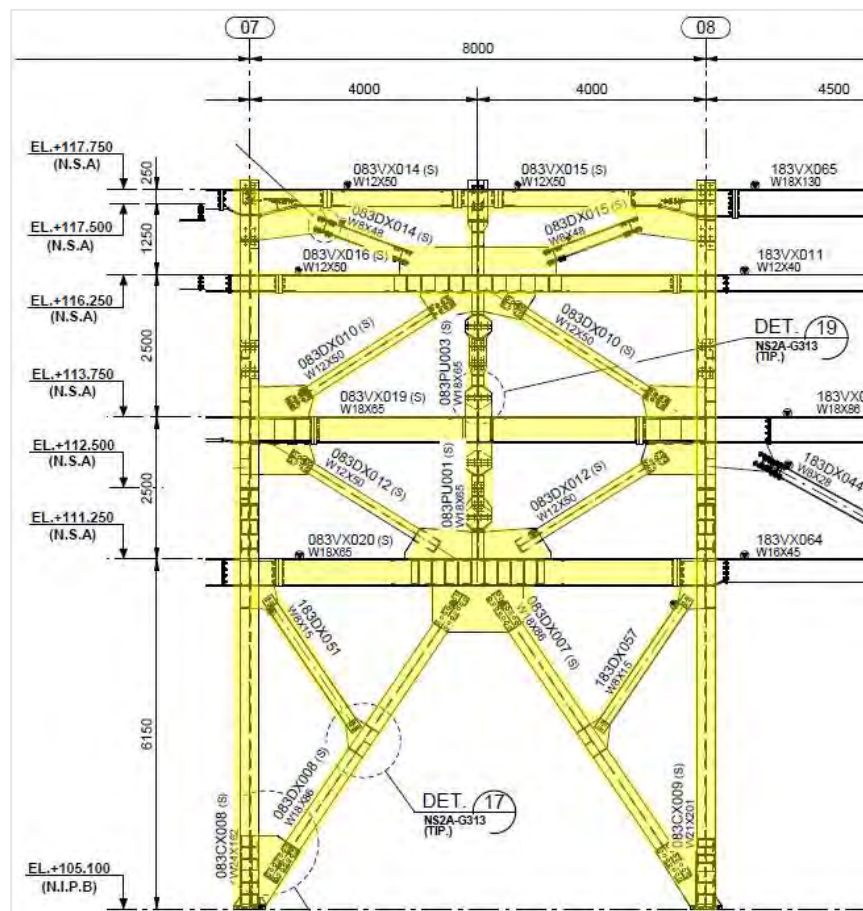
Vista de alzado compuesto del rack NS2 Ejes 7-8
